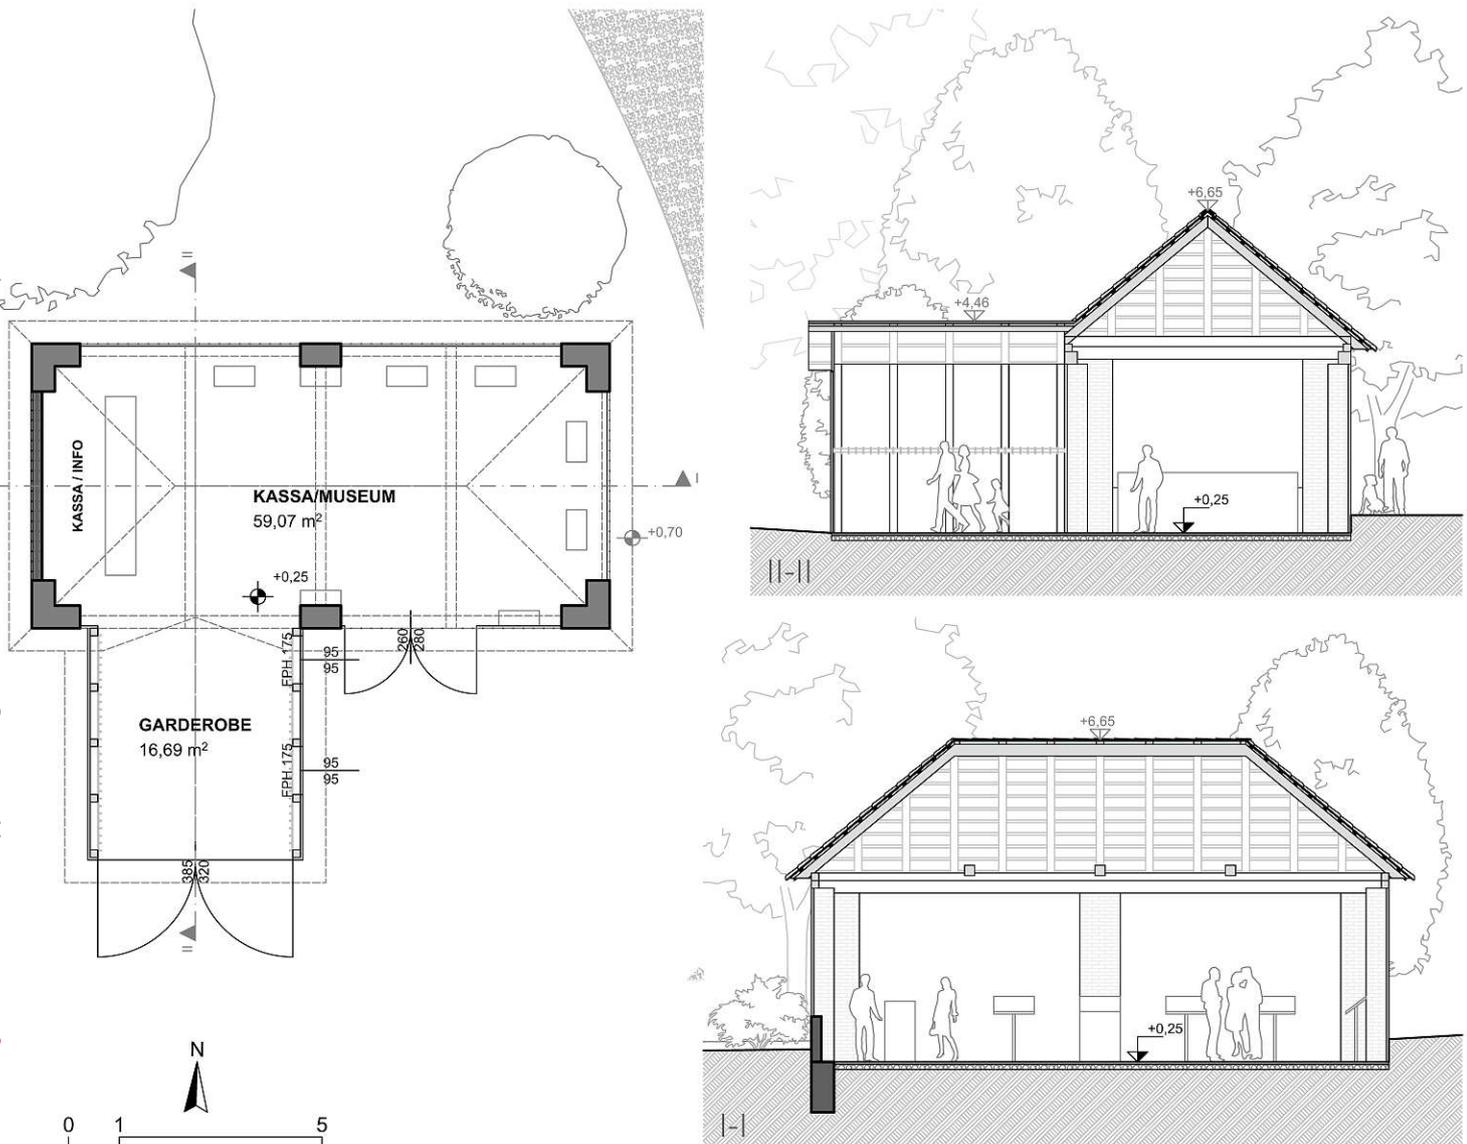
Grundriss und Schnitte Stadel – Entwurf, Maßstab 1:150.
